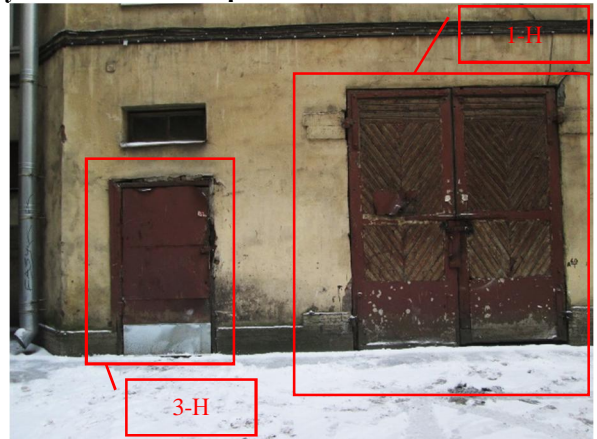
Отдельные входы со двора в помещения 1-Н и 3-Н и оконный проем над входом в пом. 3-Н
